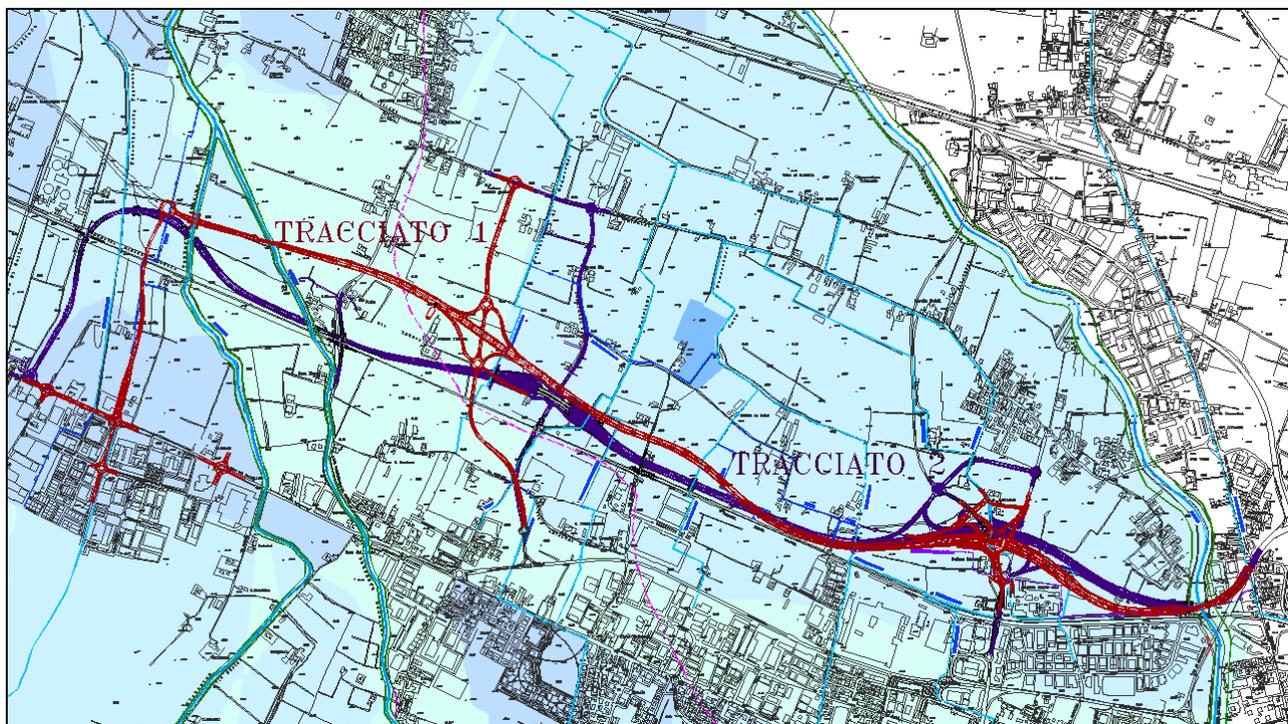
Planimetria con alternative di tracciato a confronto
